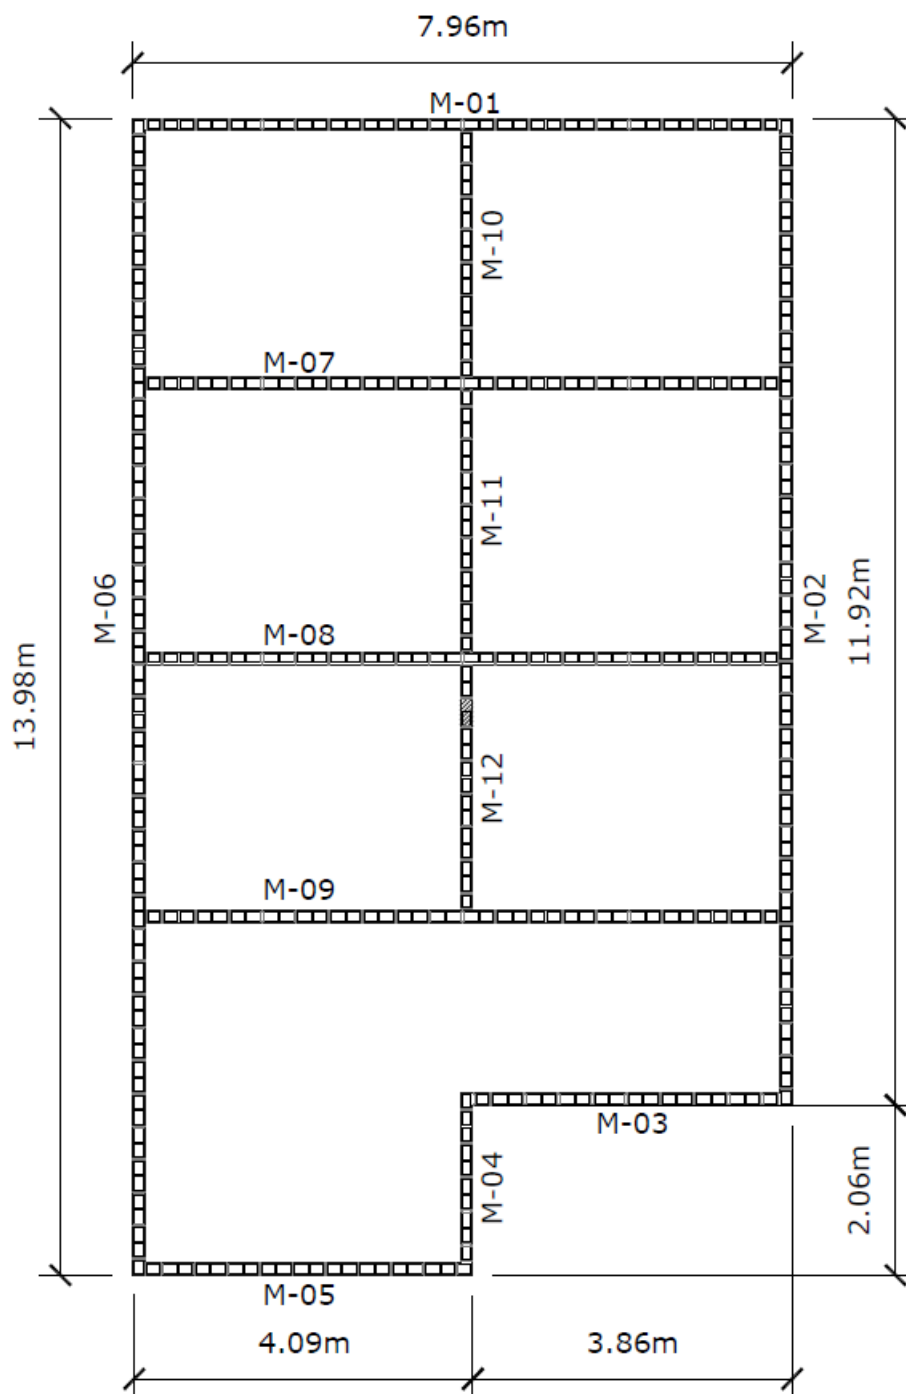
Localización de muros de mampostería - Fuente: elaboración propia.
